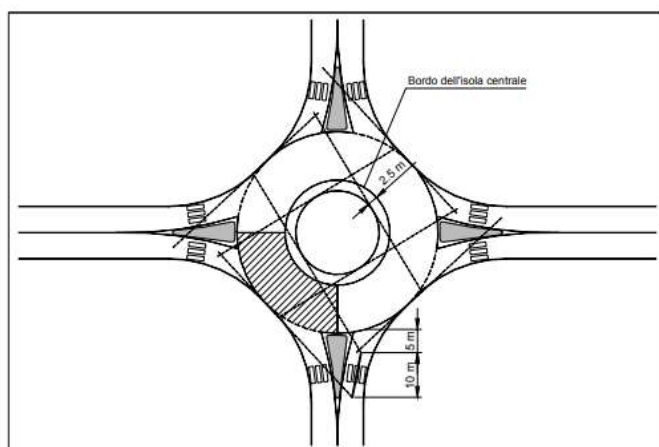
Estratto dalla tavola "Stato di progetto – Planimetria verifiche geometriche, raggi di deflessione"
